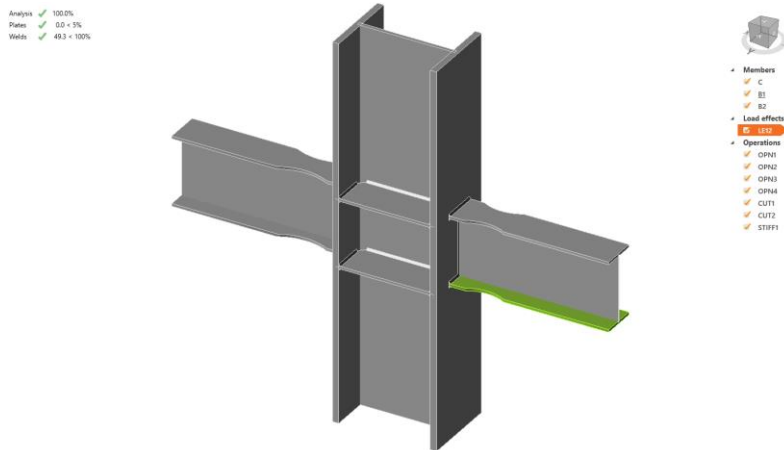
Conexión RBS con cargas aplicadas en sus elementos
